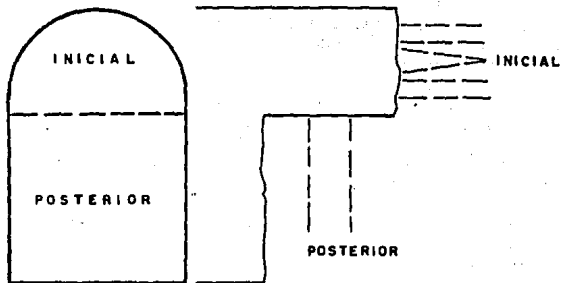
Construcción de túneles con avance por partes (primero la superior y después la inferior).
